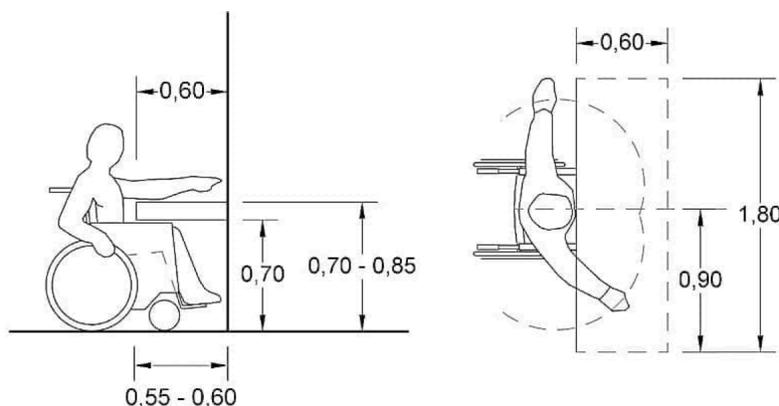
14. Alcance manual sobre un plano horizontal desde una silla de ruedas (cotas en metros)
